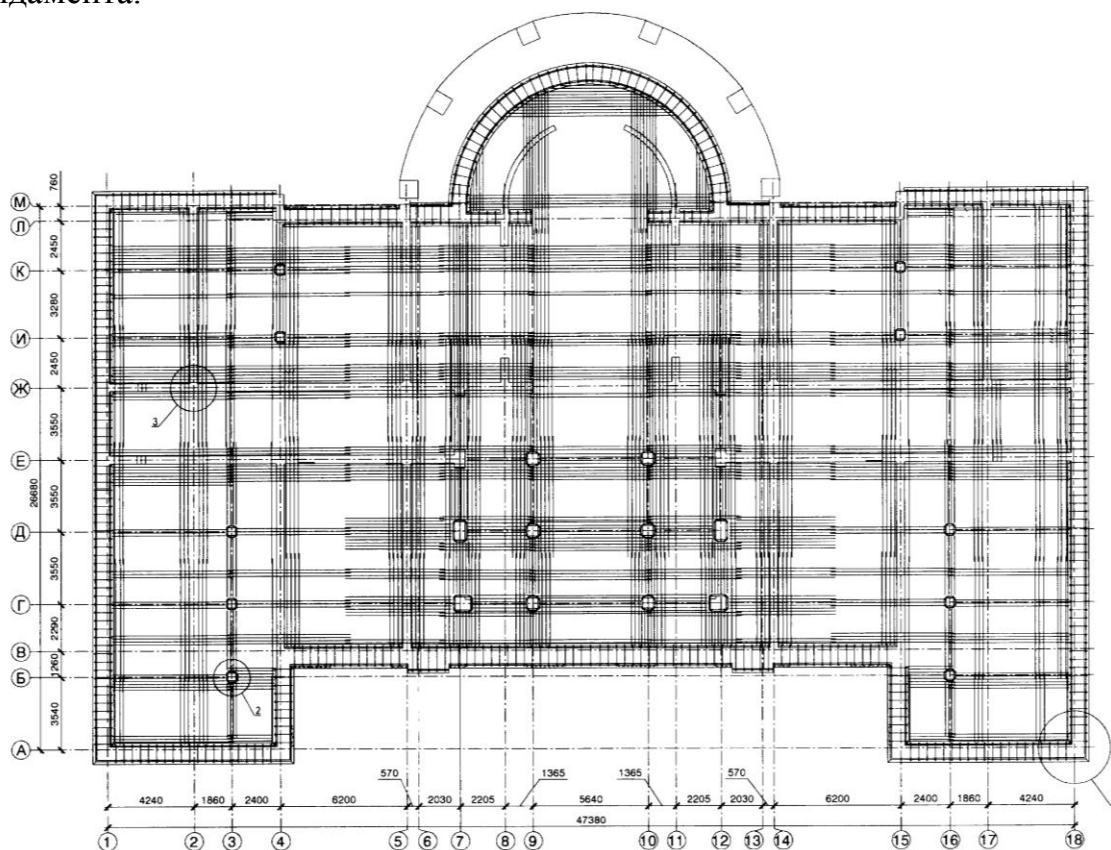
Вариант конструктивного решения с устройством монолитной железобетонной фундаментной плиты-распорки поверх существующих фундаментов под всем зданием (схема армирования)
